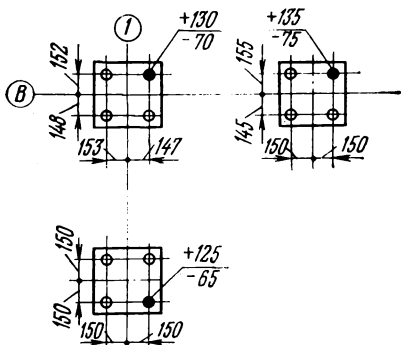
Схема исполнительной съемки фундаментов с анкерными болтами
